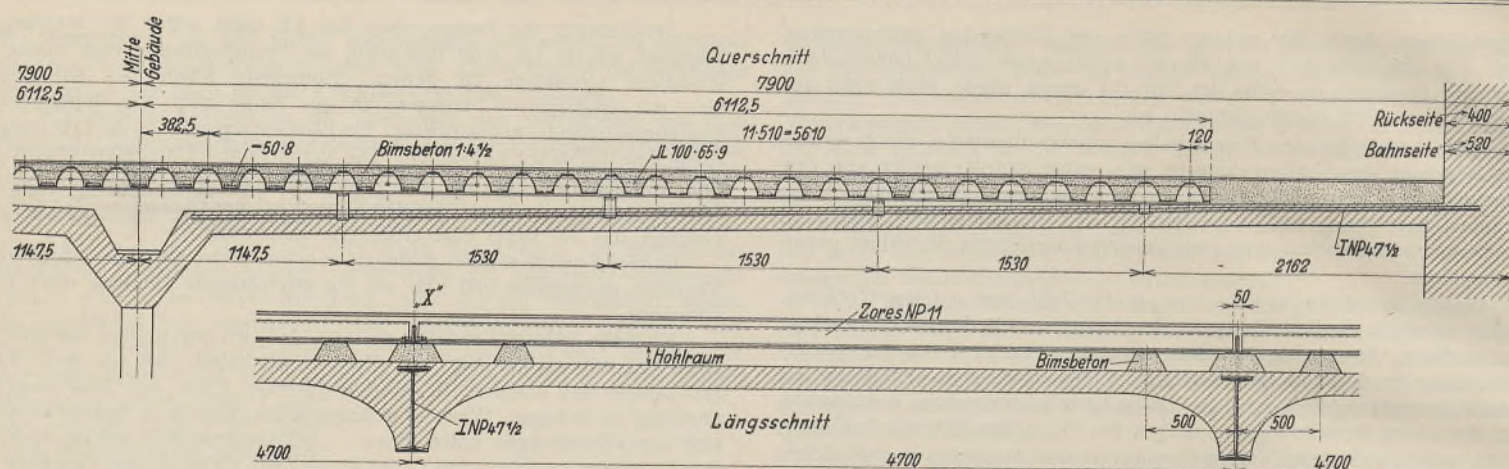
Neue Fußbodenkonstruktion über der alten Dachdecke.
